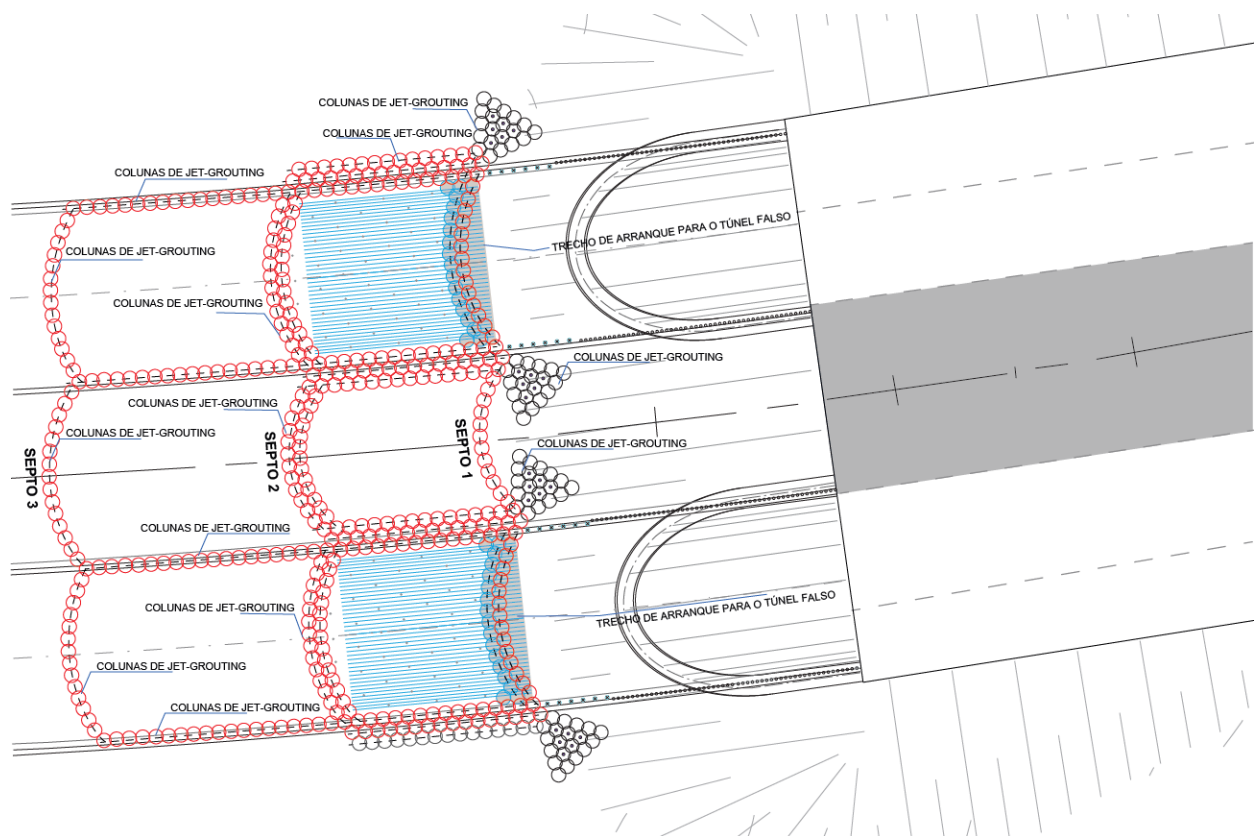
Injeções de *jet-grouting* em planta de projeto
